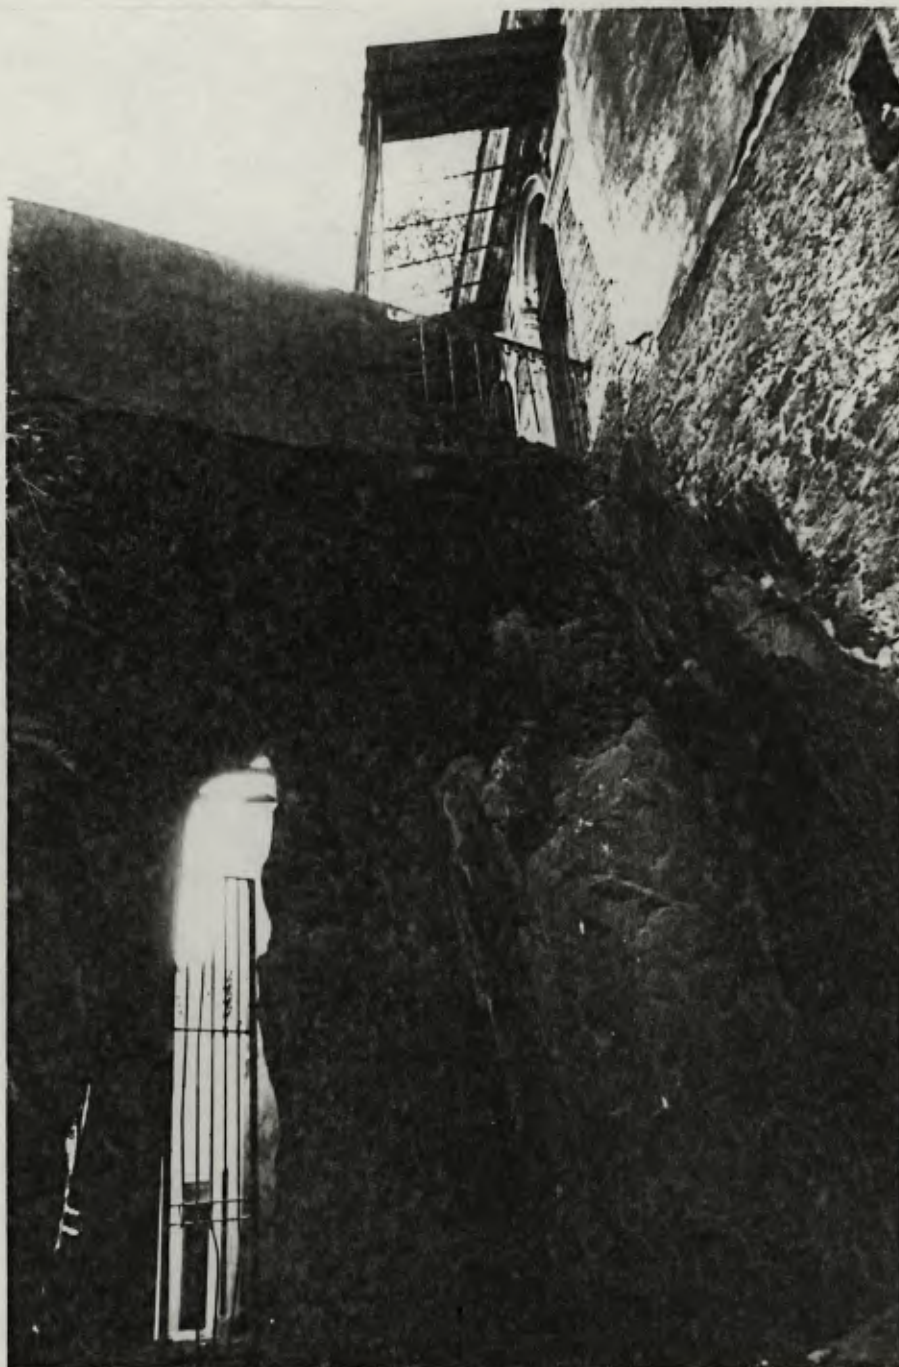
Vista da abóbada a berço de tijolos, arrematada por um arco pleno e outro ogival, provável acesso original da edificação.
